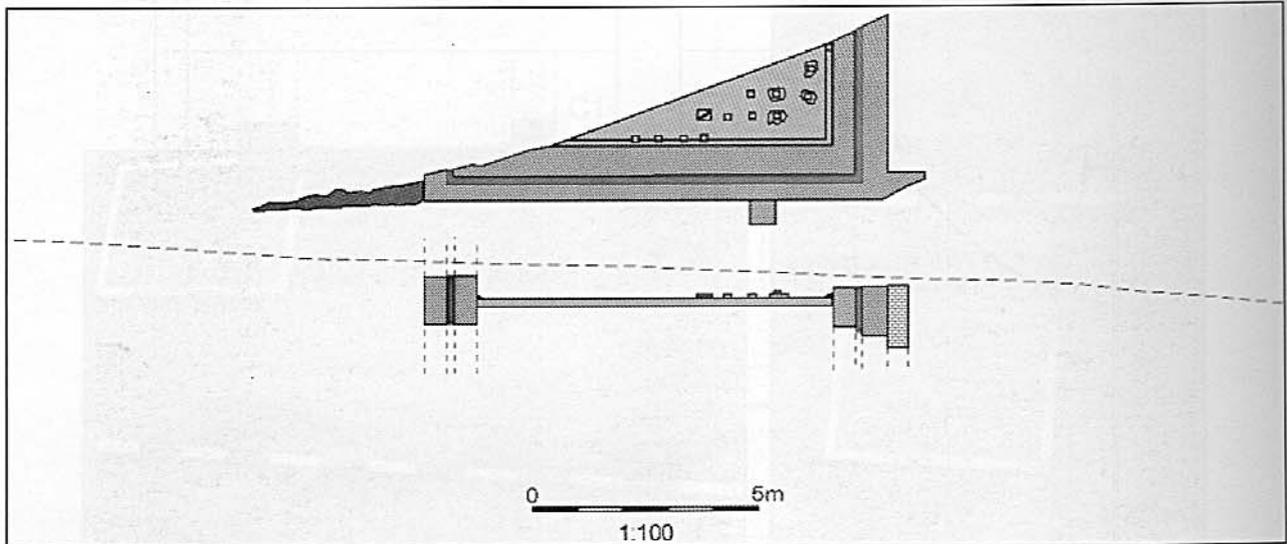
Plano y perfil de la estructura con hipocausto.
